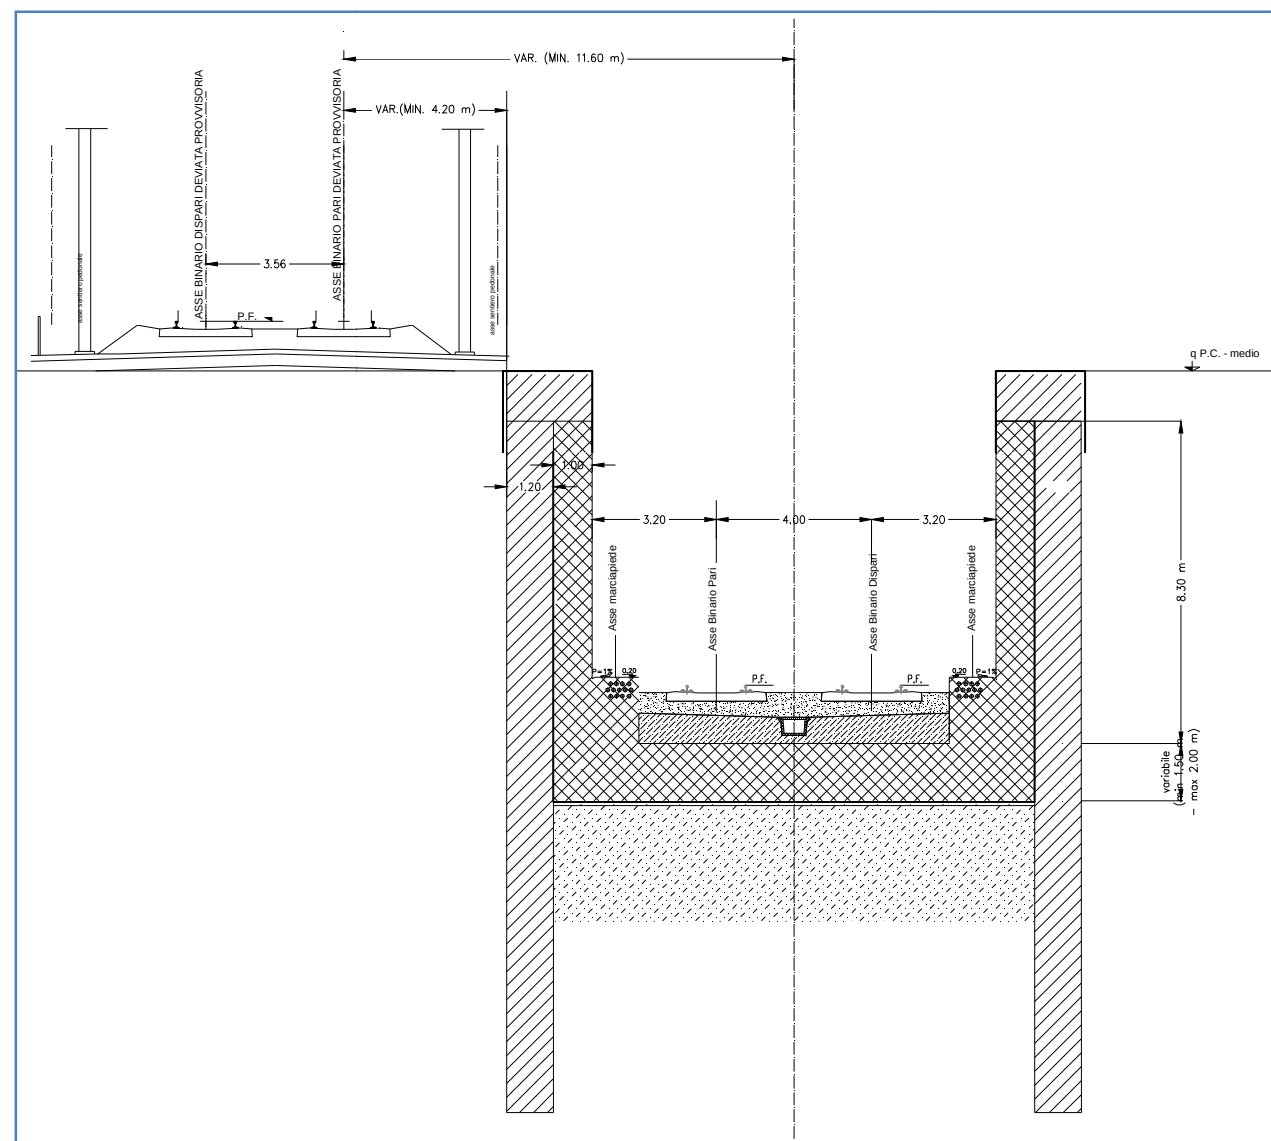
Soluzione 1 – Sezione trasversale in trincea
